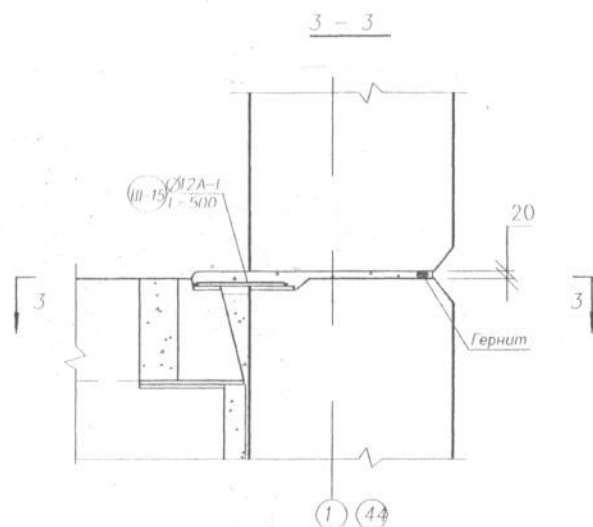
Стык двух балконных плит и панелей перекрытия
